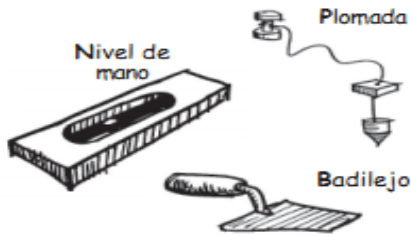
Equipos para la construcción del muro (Blondet, 2005).
